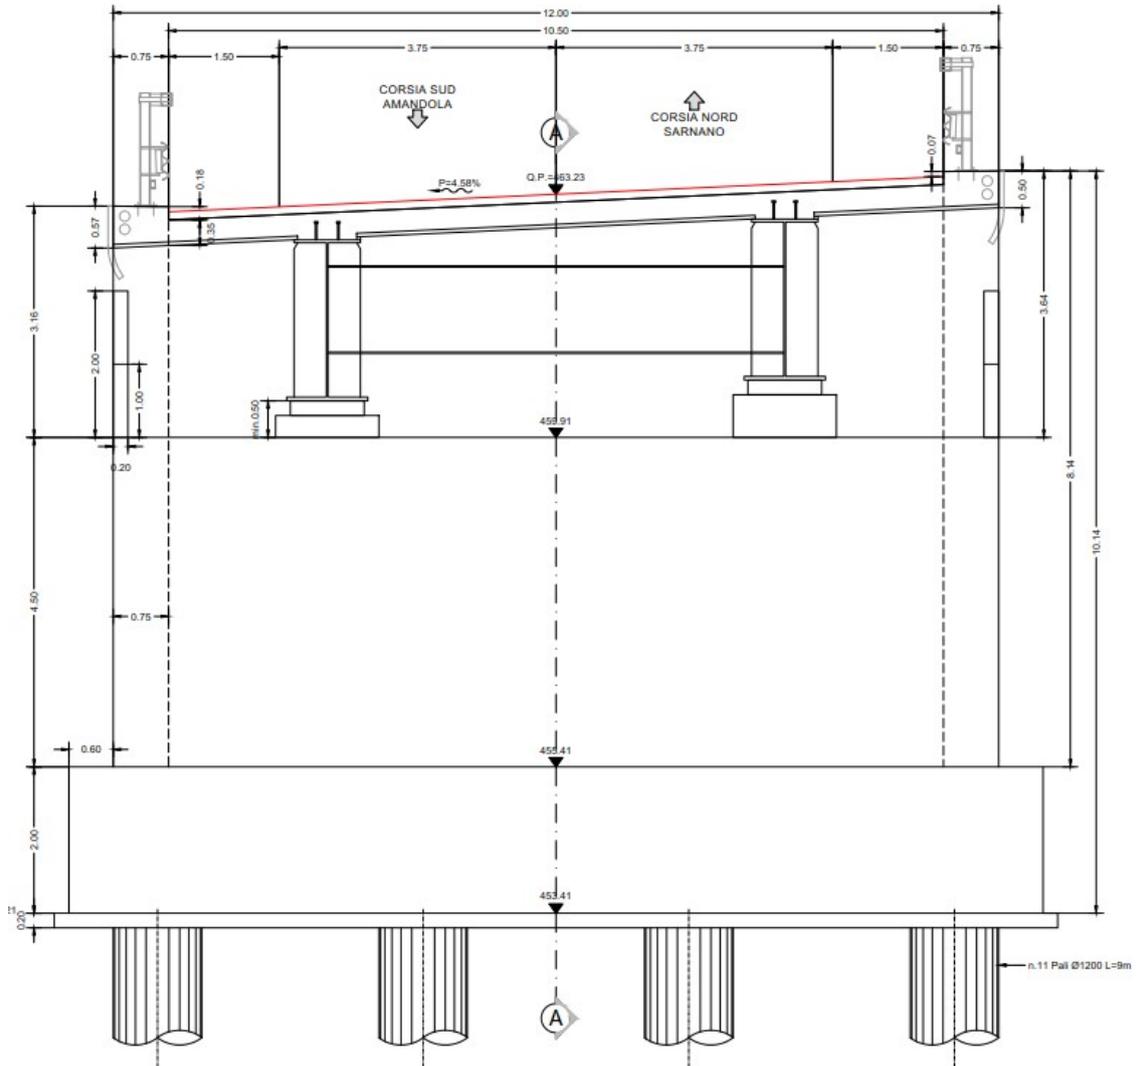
Vista frontale spalla A lato Sarnano
